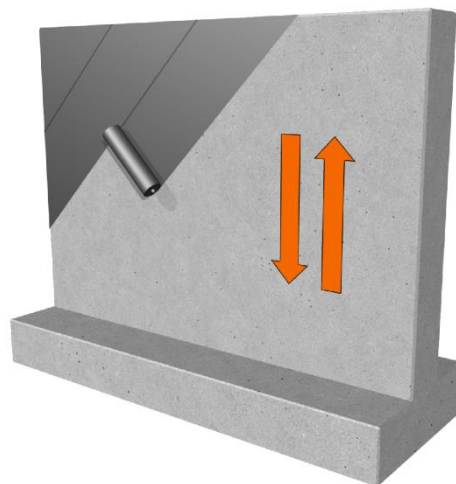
Refuerzo MasterBrace® FIB (a 90°)
